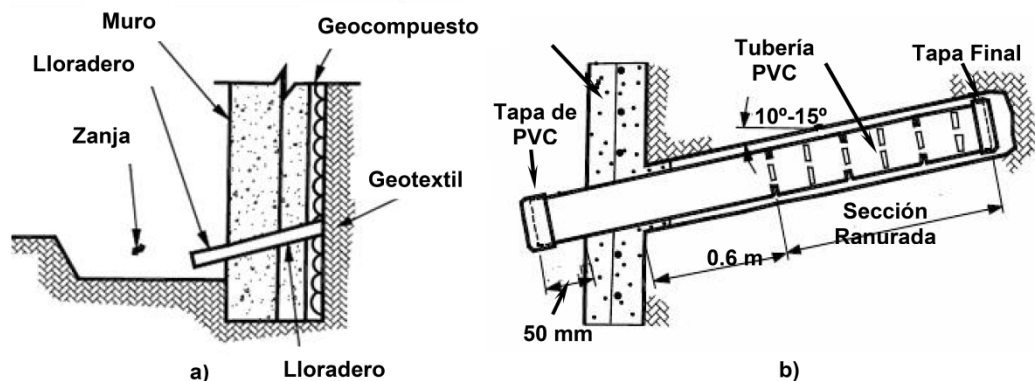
a) Lloradero de PVC en drenaje de pie; b) Lloradero de PVC en la cara del muro.
